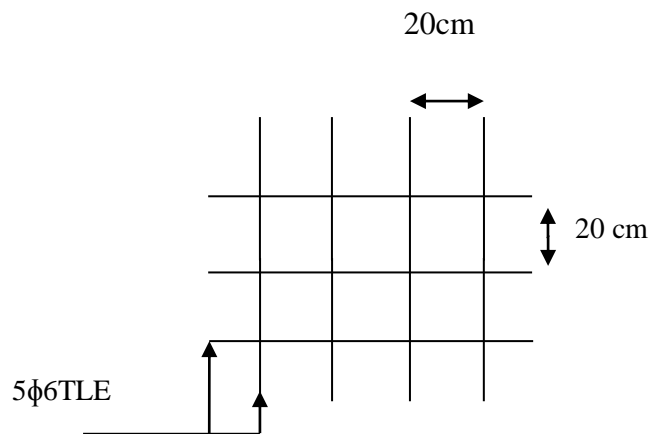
Ferrailage de la dalle de compression avec un treillis soudé.
